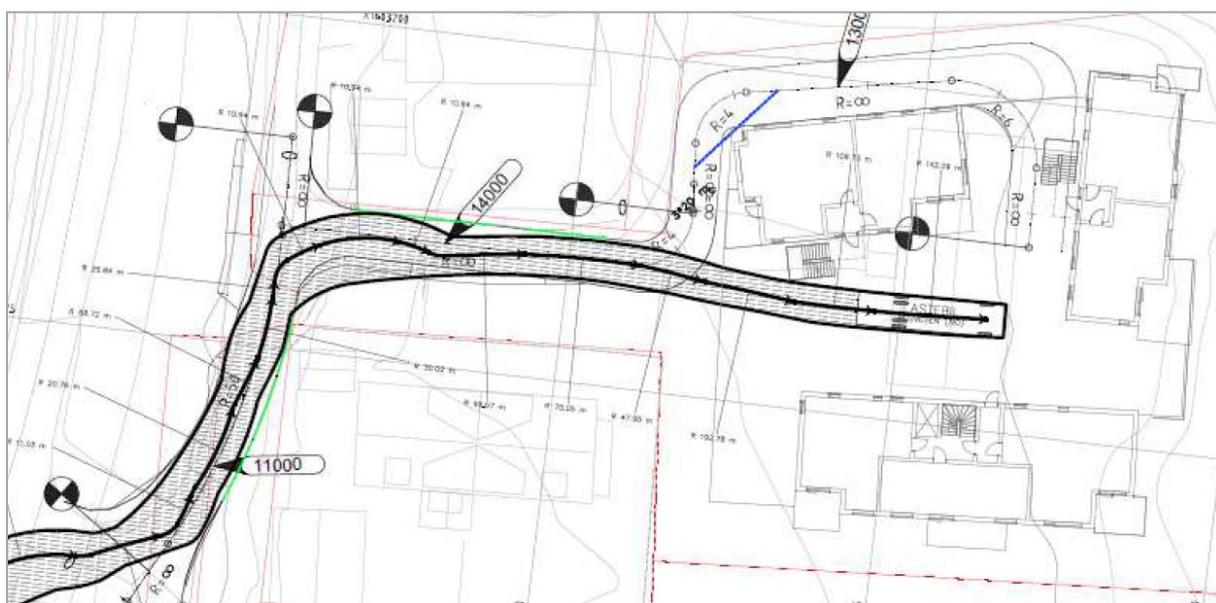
Utdrag fra vegplan. Illustrasjon: Vianova Trondheim.
